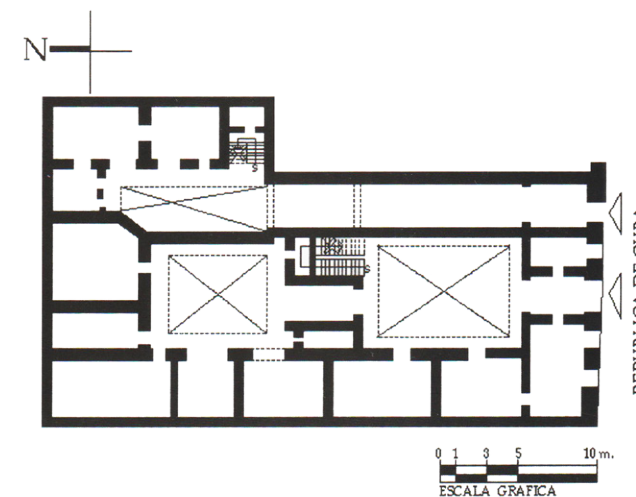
Ortiz, R. (2018) *Planta Baja*. [planta arquitectónica]. Fototeca CNMH/1063-075. (p. 132).
